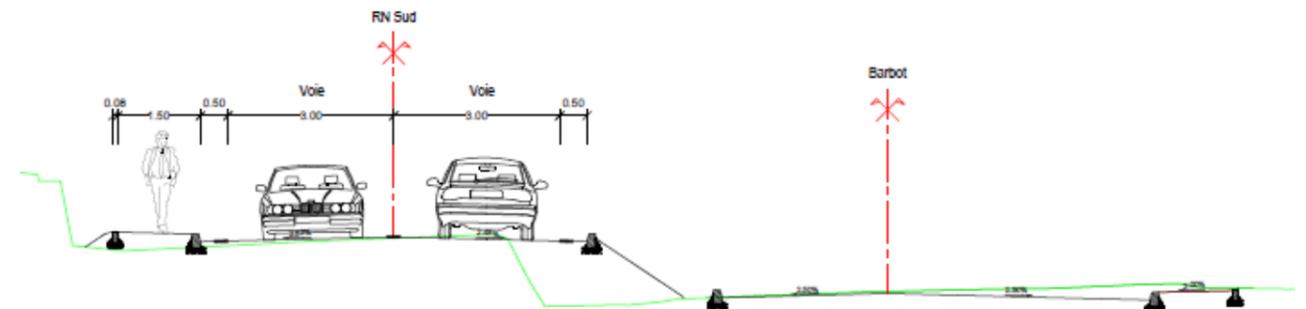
Profil en travers de la RN Sud au Sud du carrefour RN94 / Avenue du général Barbot
